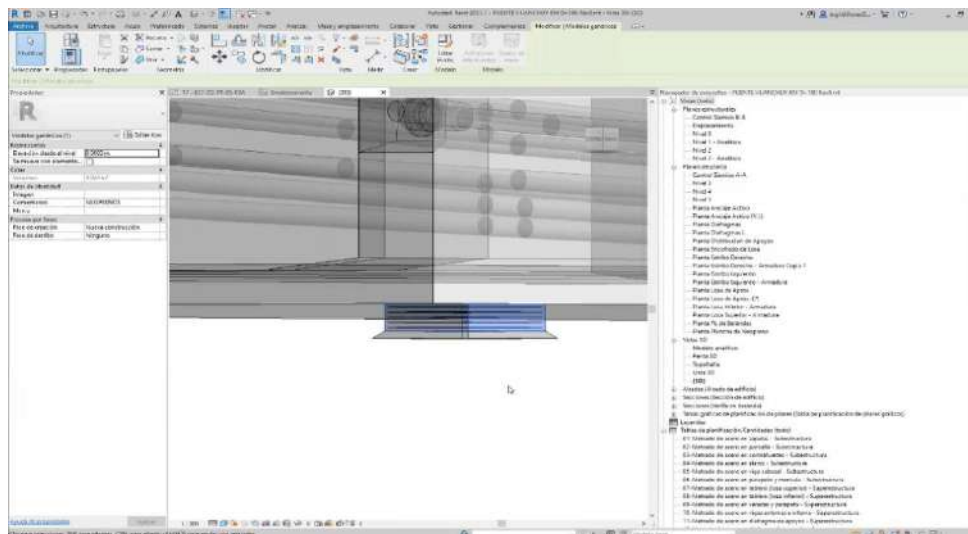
Modelado de las tuberías y sumidero para el drenaje del tablero del puente Huanchuy
